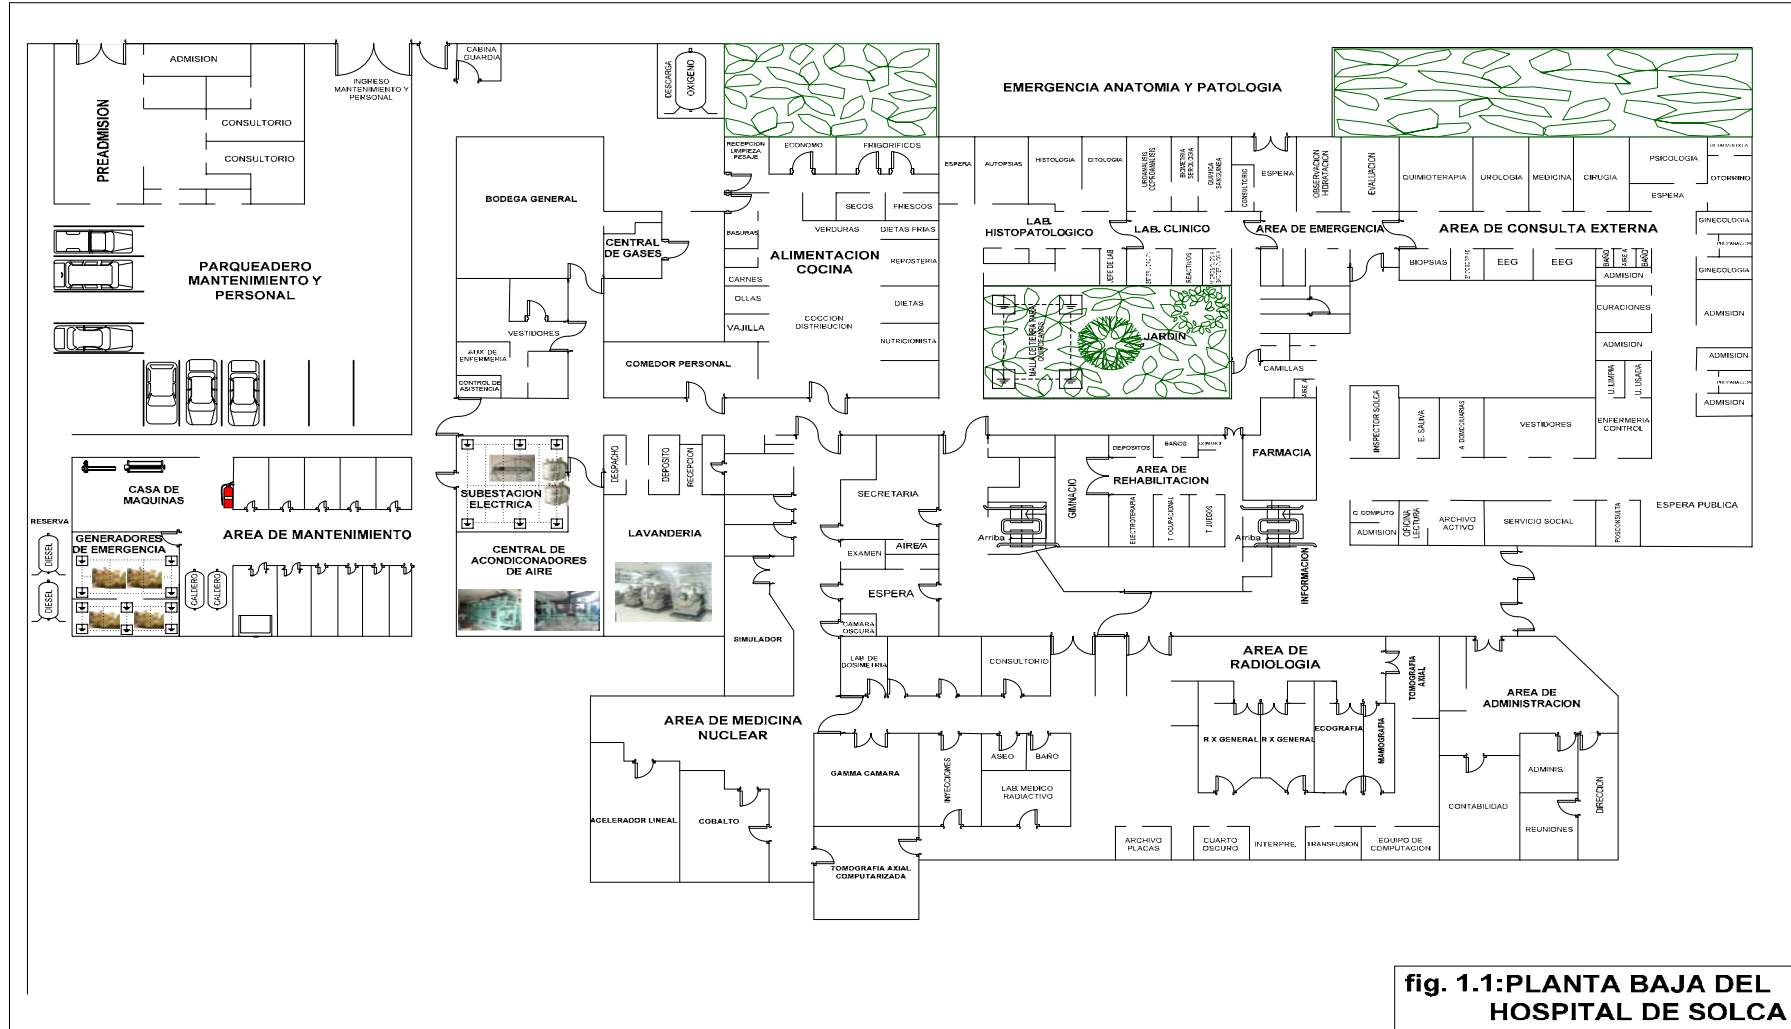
PLANTA BAJA DEL HOSPITAL DE SOLCA
